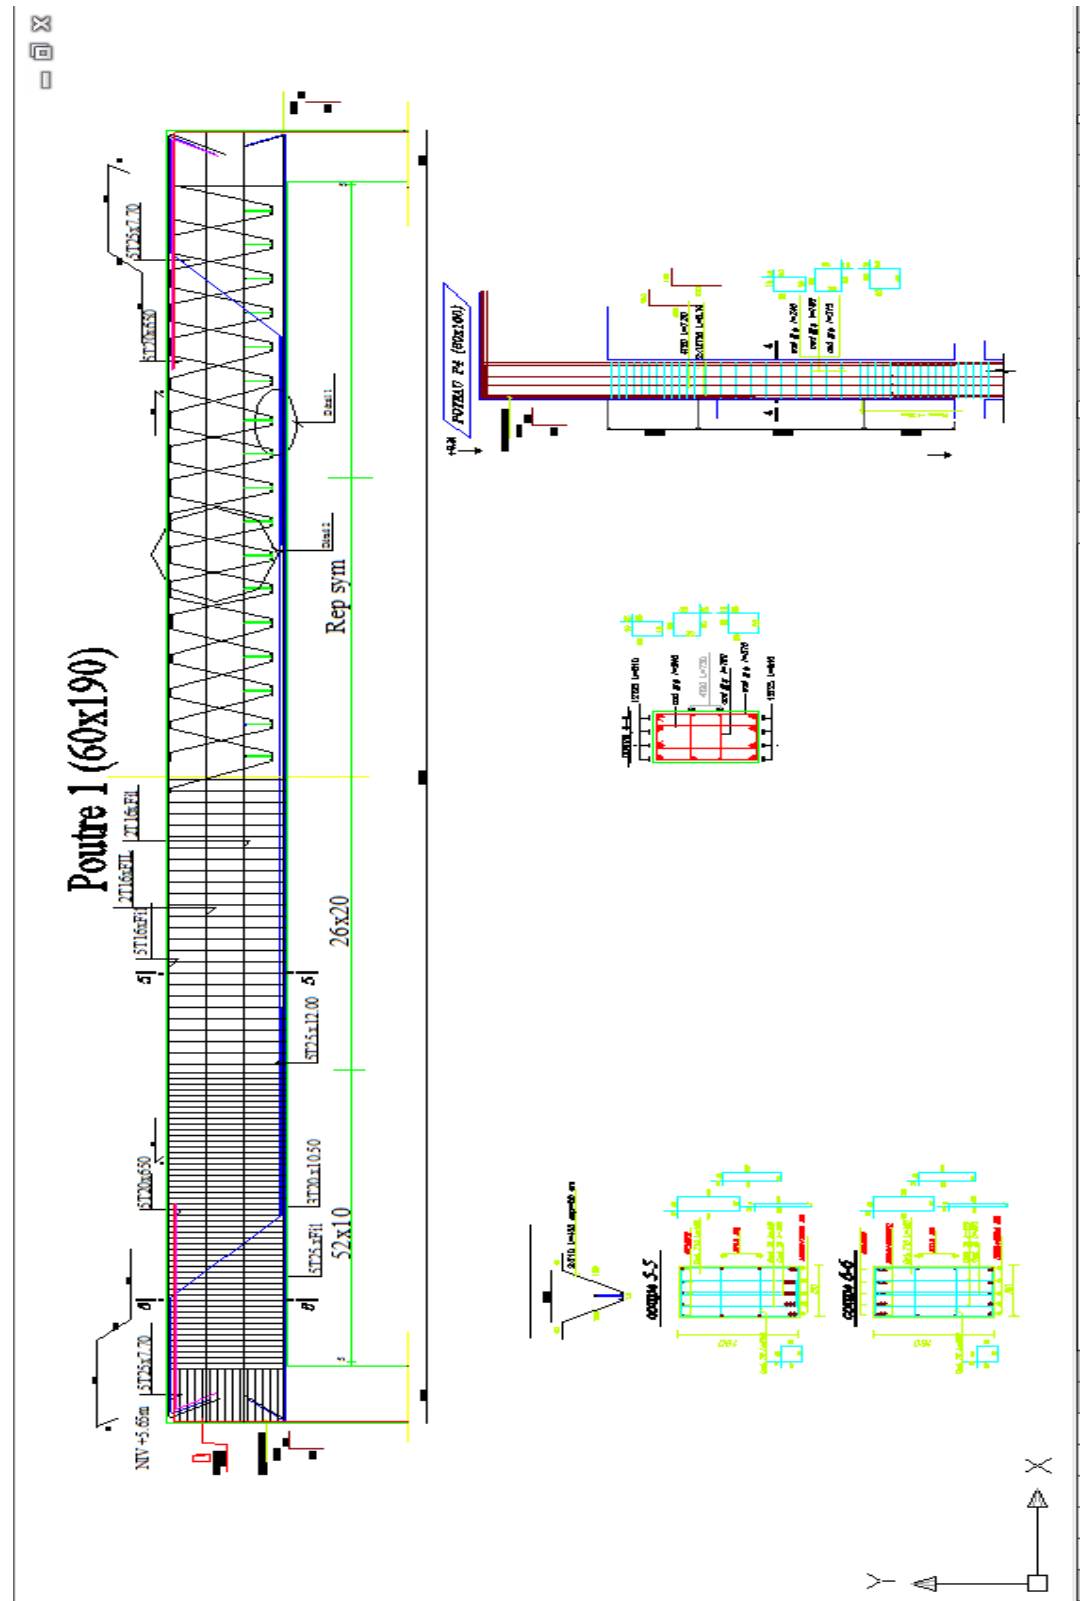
Ferrailage des poutres et poteaux échelle 1/20. [2]
